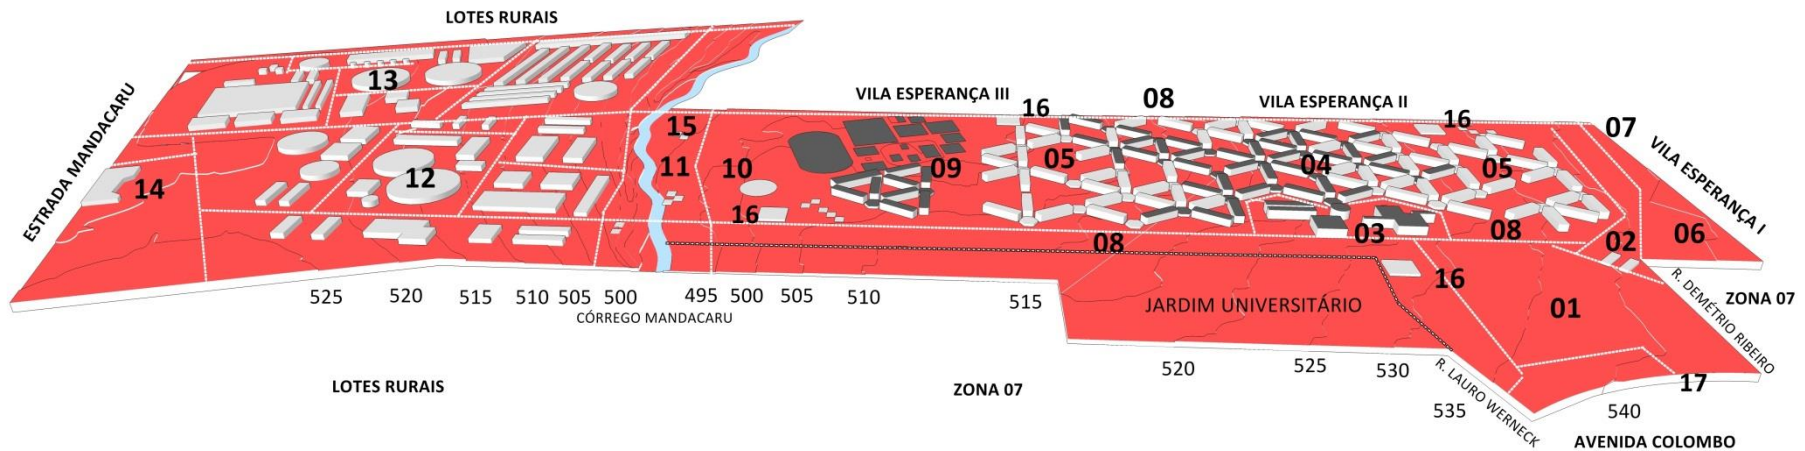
Implantação Plano Piloto 1977. Fonte: Mapa Base Prancha 01 – Plano Piloto 1977. Disponível na DOP/PTO. Desenho Renan Avanci.
